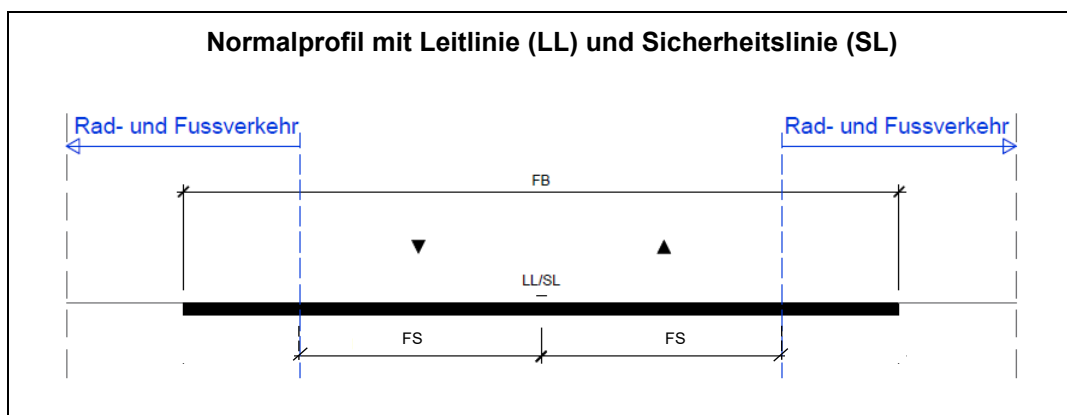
Elemente des Normalprofils Rad- und Fussverkehr innerorts einer 2-streifigen Nationalstrasse 3. Klasse (1+1 Verkehrsführung)
